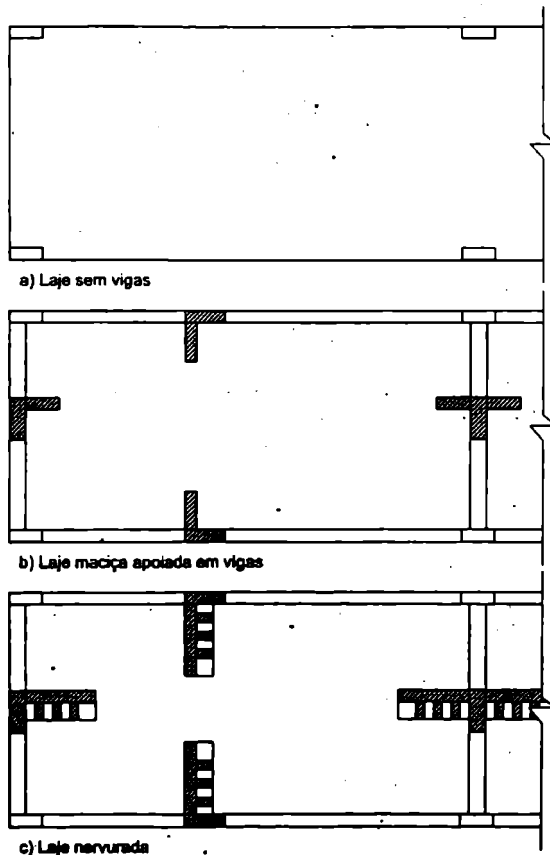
Esquemas estruturais de pavimentos de concreto.
